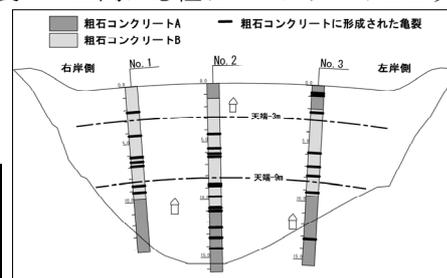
粗石コンクリートの分類と亀裂位置図
